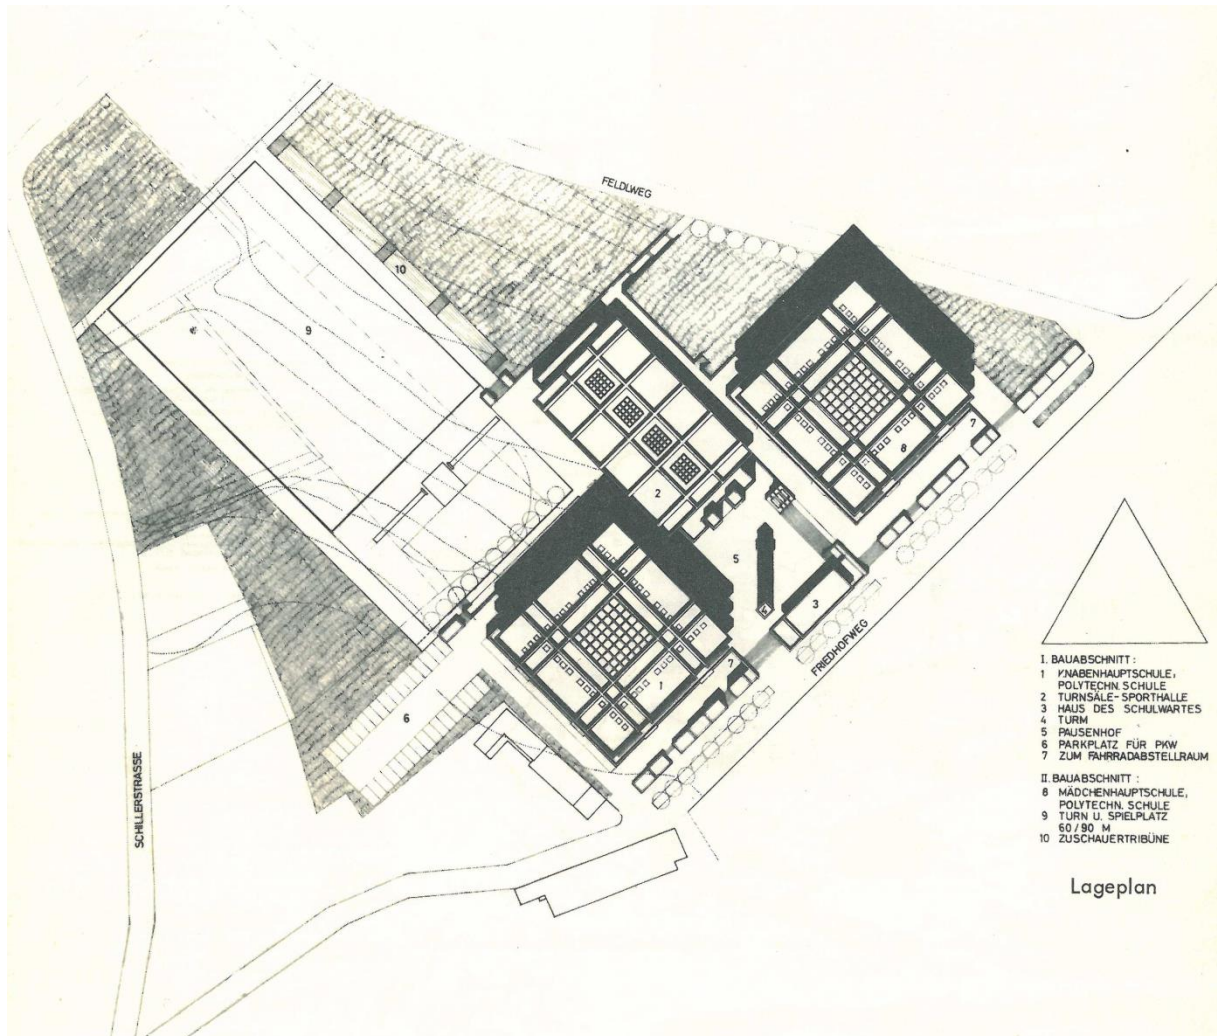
Lageplan noch mit dem alten Straßennamen Friedhofweg
